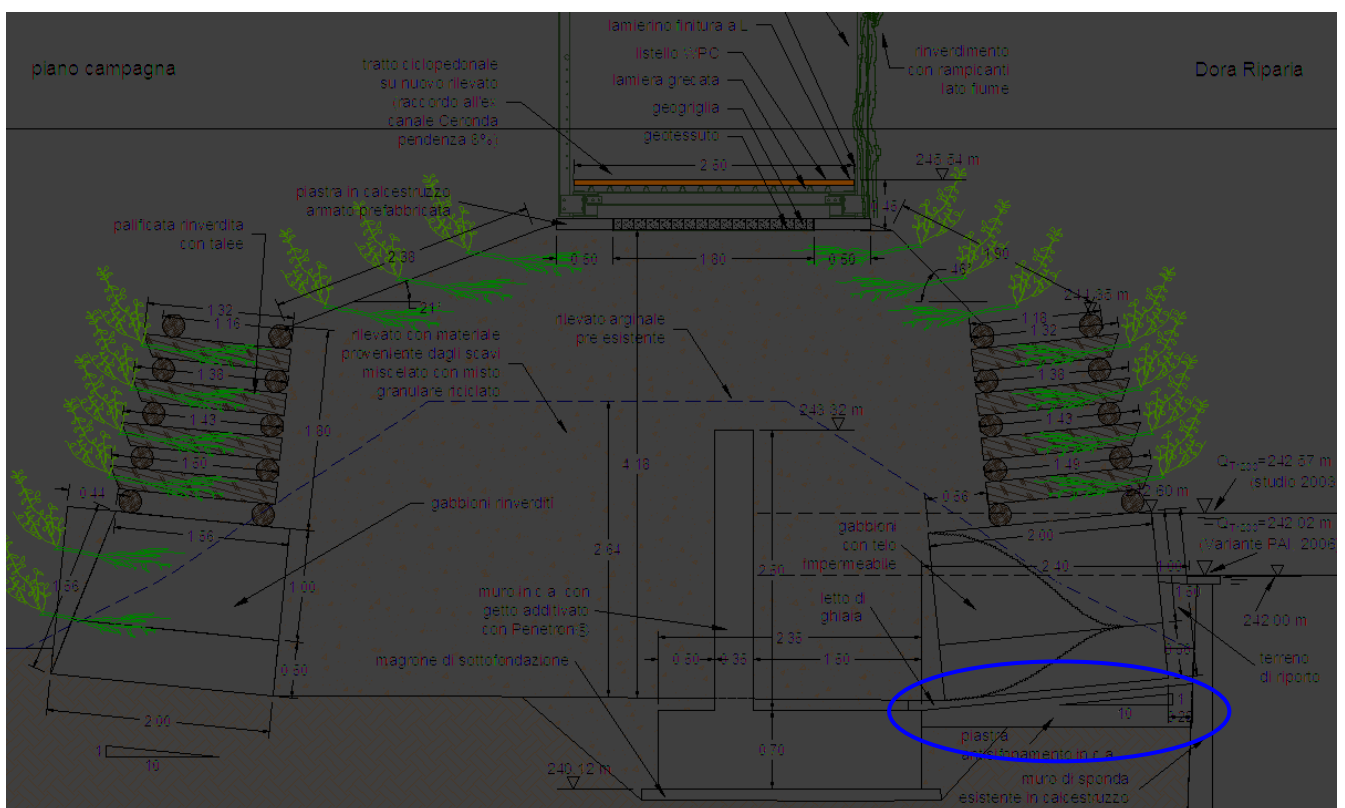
Individuazione nel setto in calcestruzzo atto ad evitare il sifonamento dell'opera.
